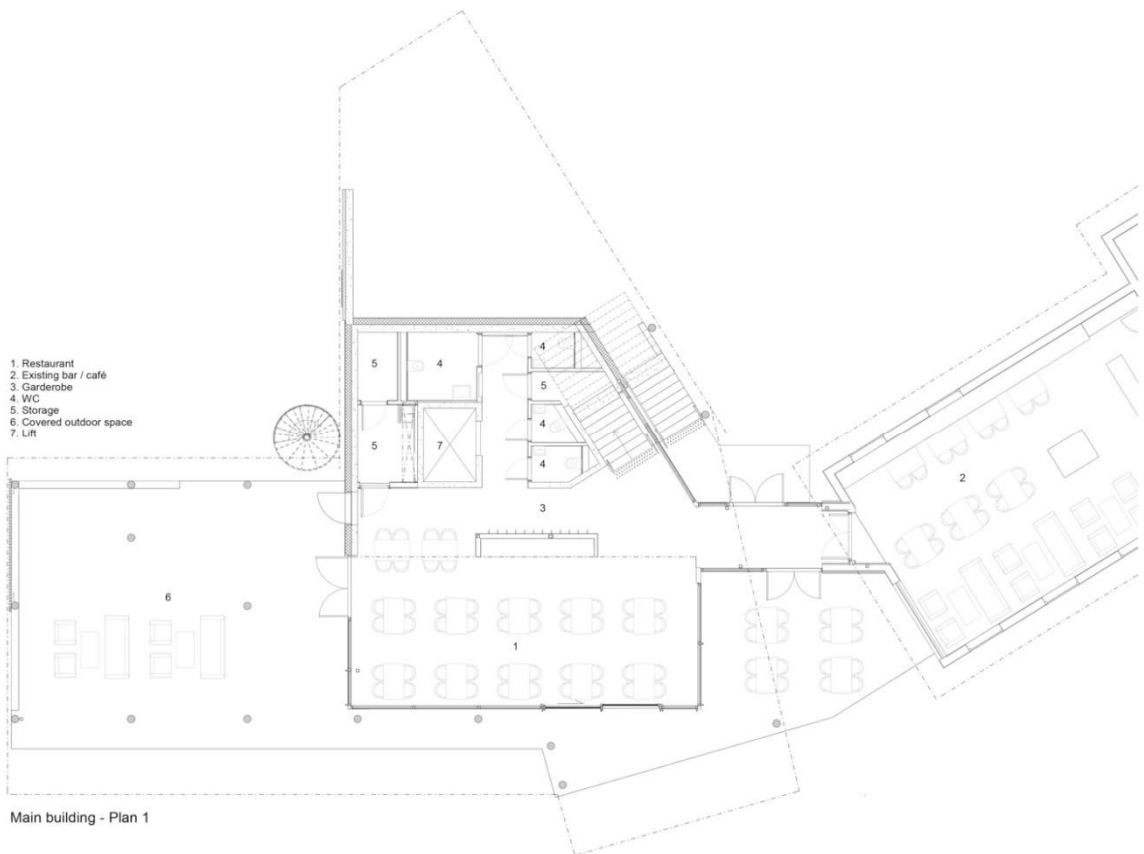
Планування головної будівлі комплексу (1-й пов.) [5].
